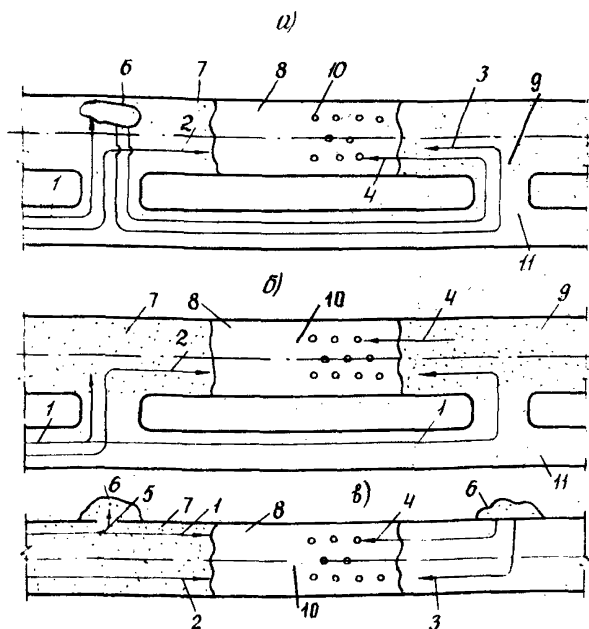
Схемы организации работ по устройству вертикальных песчаных дрена: 1-автовозка песка; 2-то же, суглинка; 3-перевозка песка со склада автомобилями, скреперами; 4-то же, транспортными тележками (для дрена); 5-дополнительная перевозка песка на склад; 6-склад песка; 7-нижний дренарующий слой; 8-суглинок; 9-верхний дренарующий слой; 10-вертикальные дрена; 11-подъездной путь
